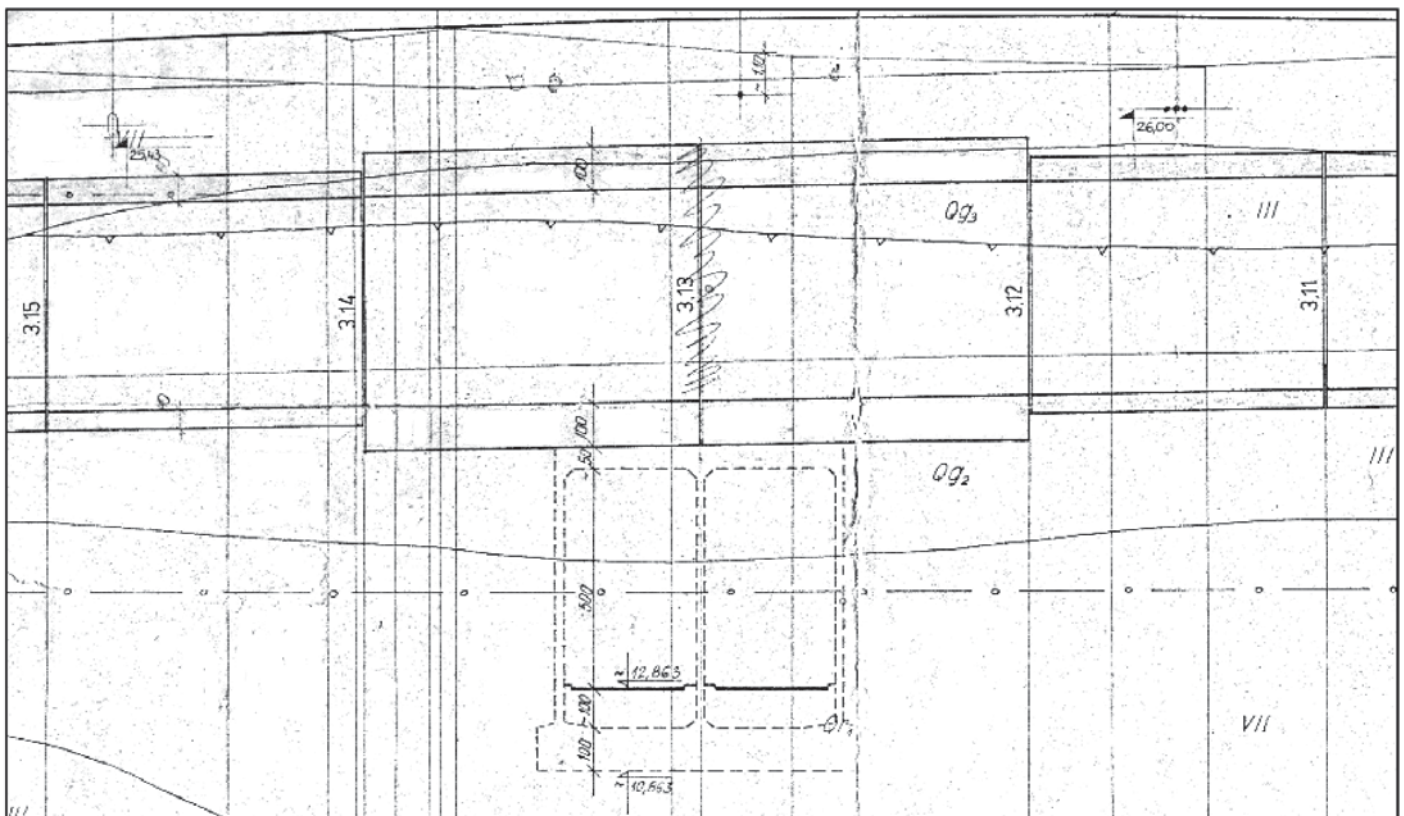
Przekrój poprzeczny segmentu wzmocnionego tunelu metra (graf. Metroprojekt lata 80)
